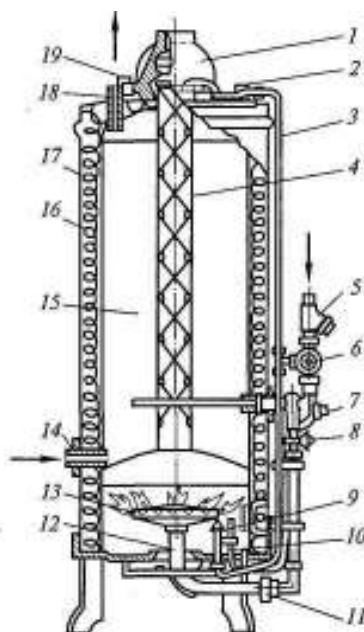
Автоматический газовый водонагреватель АГВ-80:
